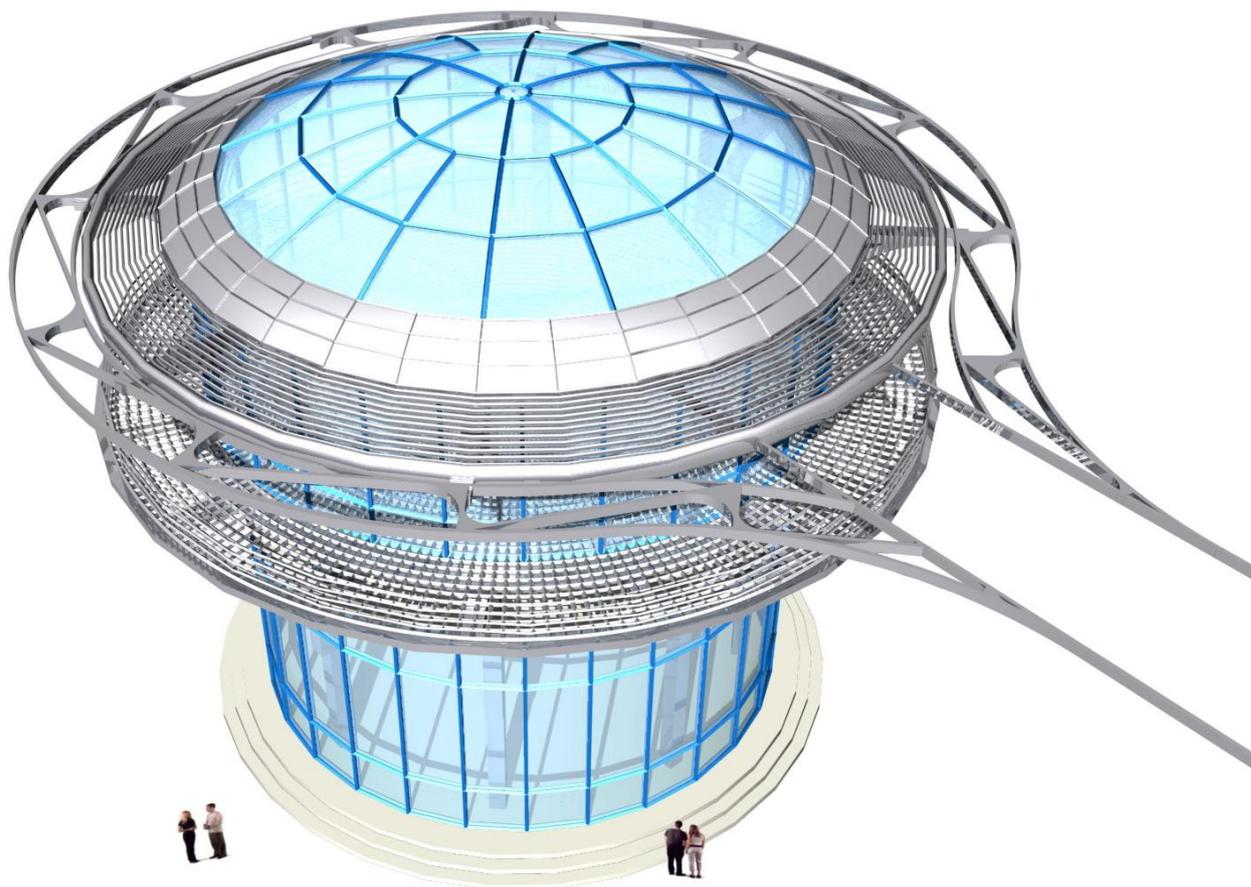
Разворотная станция двухпутного моноСТЮ (вид сверху)
